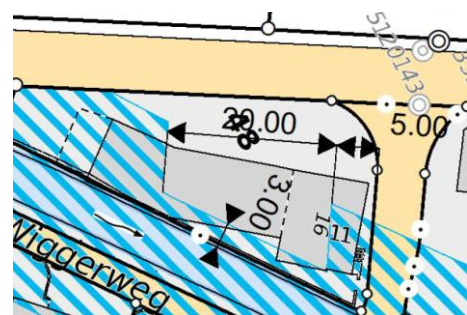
Planausschnitt, Teilzonenplan GewR für 2. Eingabe Vorprüfung
